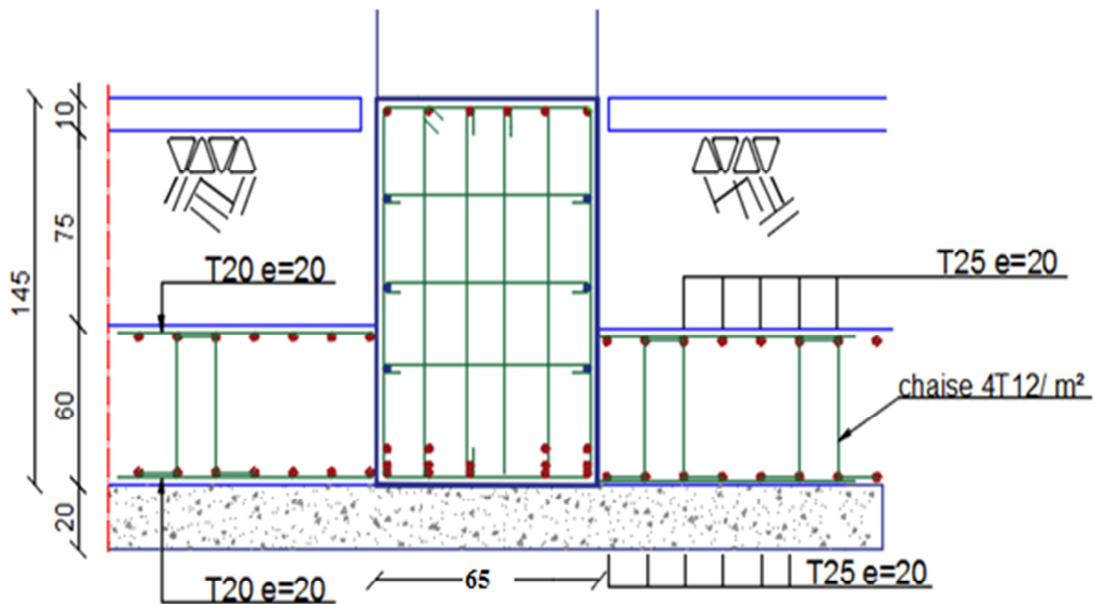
exemple Ferrailage de radier aux travée sens x-x.
